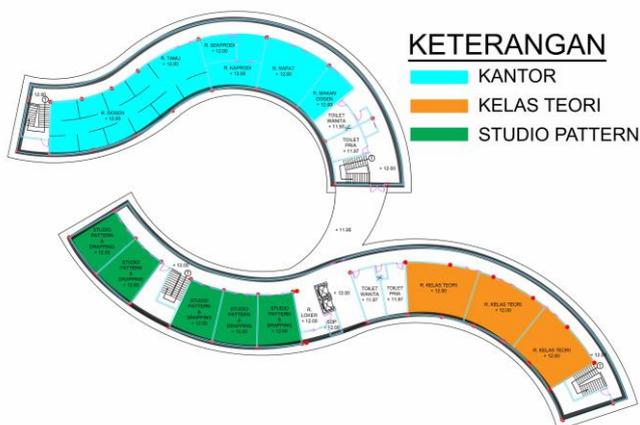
Denah Lantai 2. Sumber: penulis
